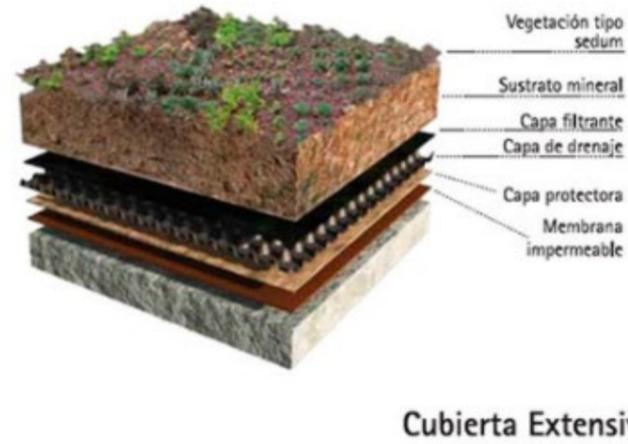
Corte de cubierta extensiva. Fuente: <https://cubiertasverdesmedios.wordpress.com/sistemas/detalles-constructivos/>
